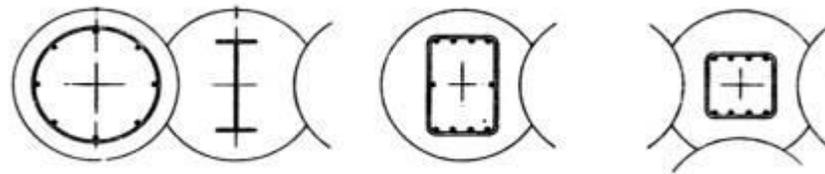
Diversas opciones para acero de refuerzo en pilas secantes
